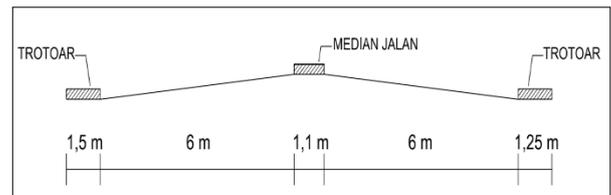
Geometrik Melintang Jalan A. Yani Sebelum Peningkatan Struktur Badan Jalan
